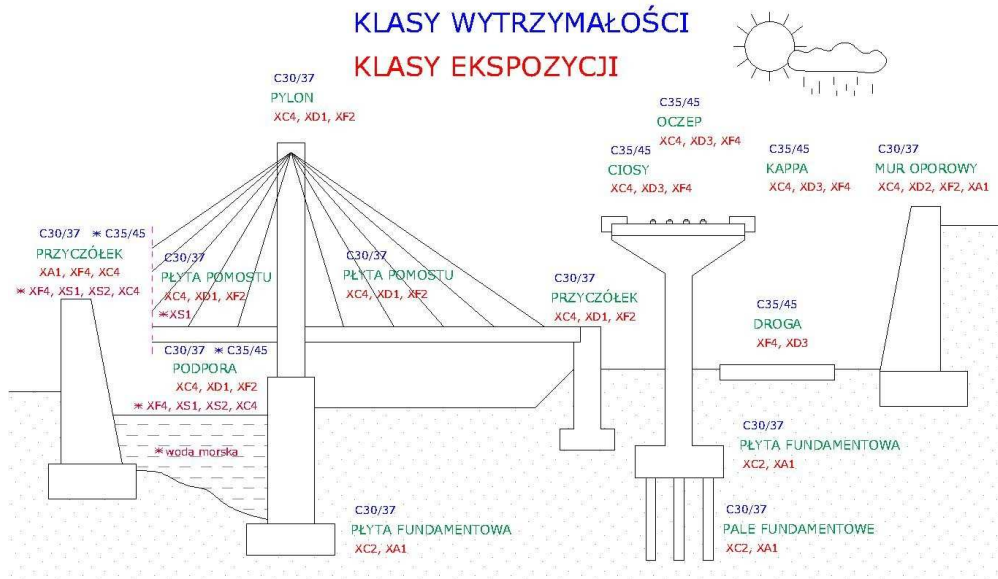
Zakres specyfikacji betonu do elementów konstrukcji mostowych [15]
